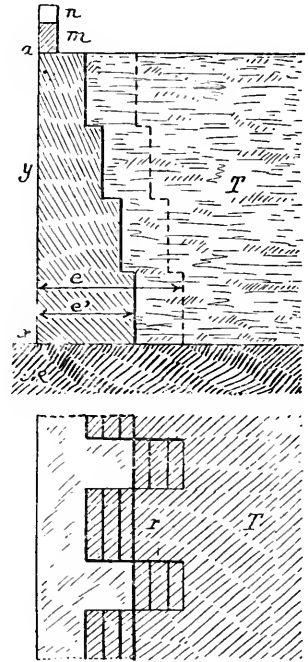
Coupe en élévation et plan du mur de soutènement d'une butte.
